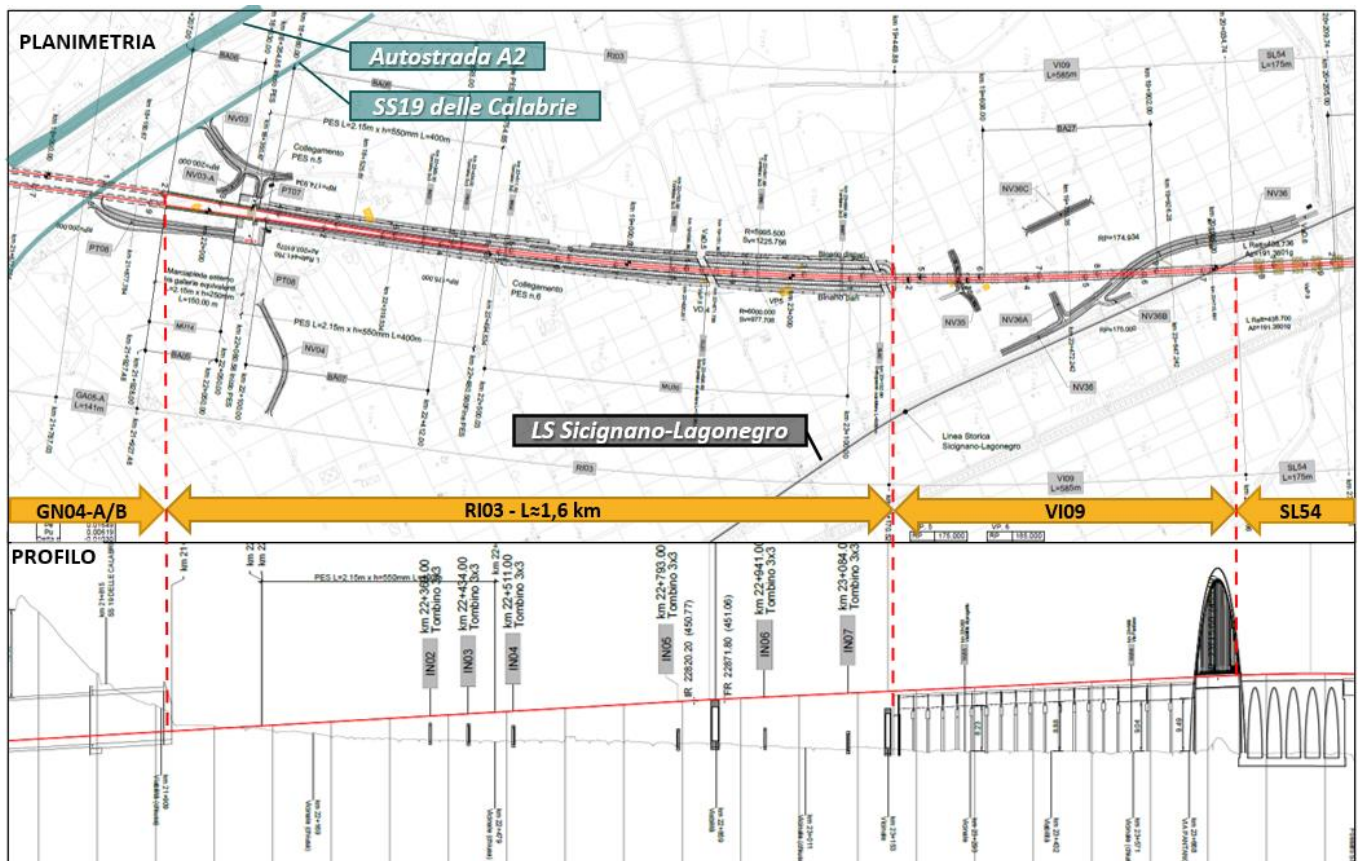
Planoprofilo di progetto da km 21+927 a km 23+755
